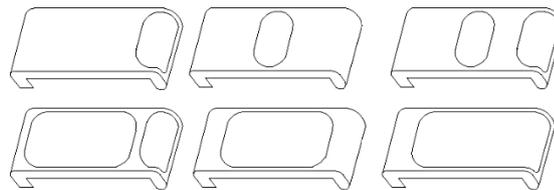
Paneles Zip Up exteriores para aislamiento, 1968.
